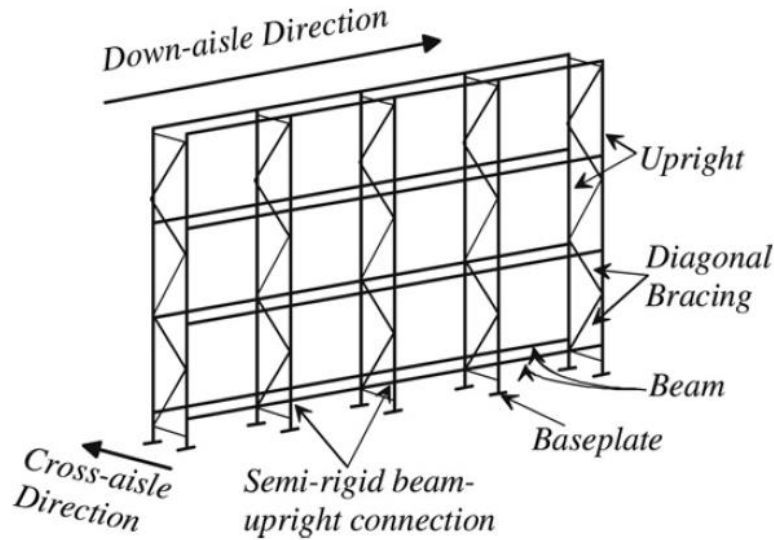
Caractérisation d'une structure en plan - [2]
